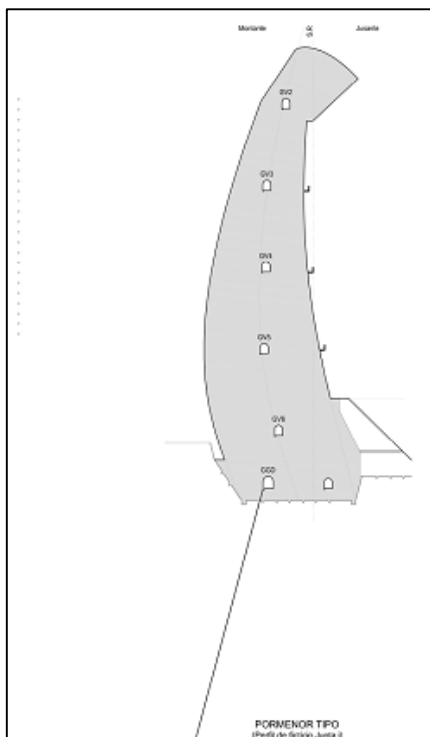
Perfil Tipo de cortina de Impermeabilização no Escalão Montante (Brandão, 2014)
